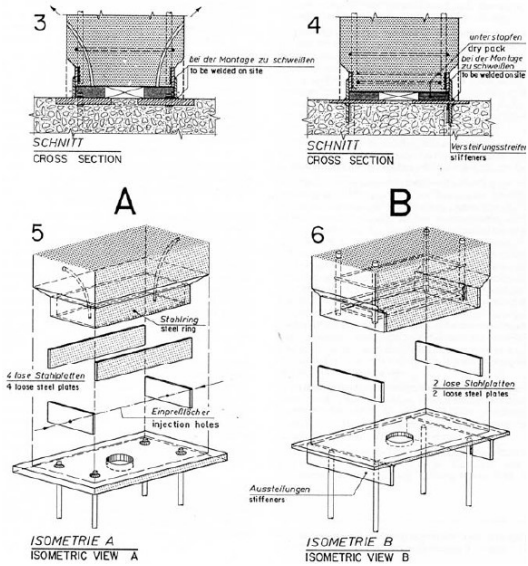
Ligação por soldagem a chapa (Stupré, 1981)
